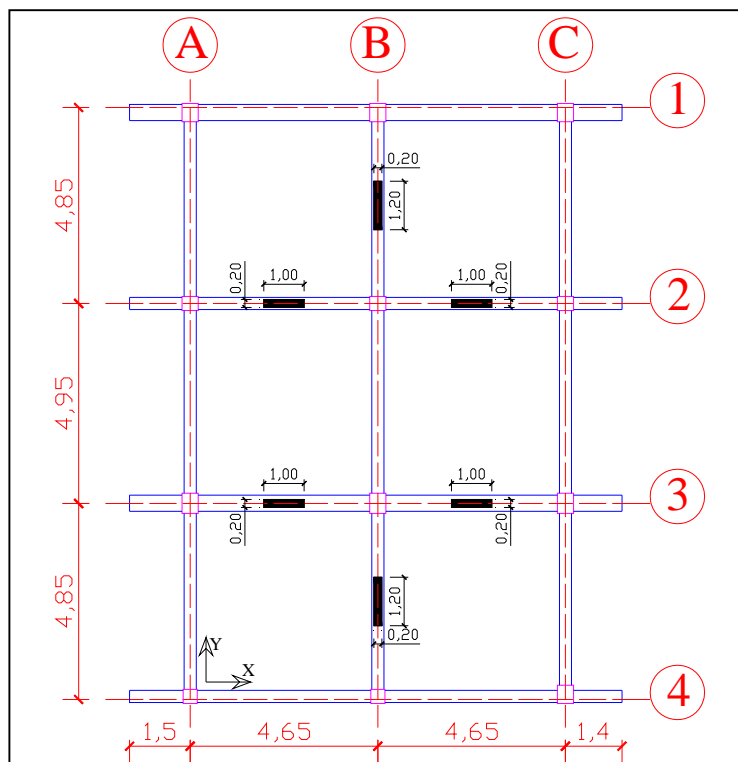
Distribución de los muros en planta, alternativa 4.
